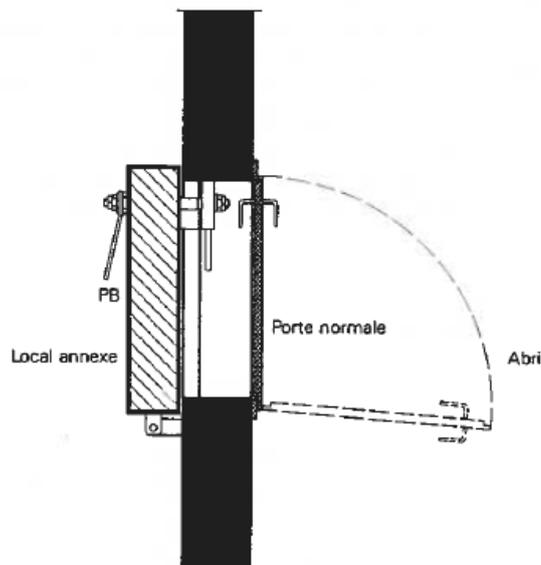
Disposition d'une porte normale près d'une porte blindée (vue en plan)
